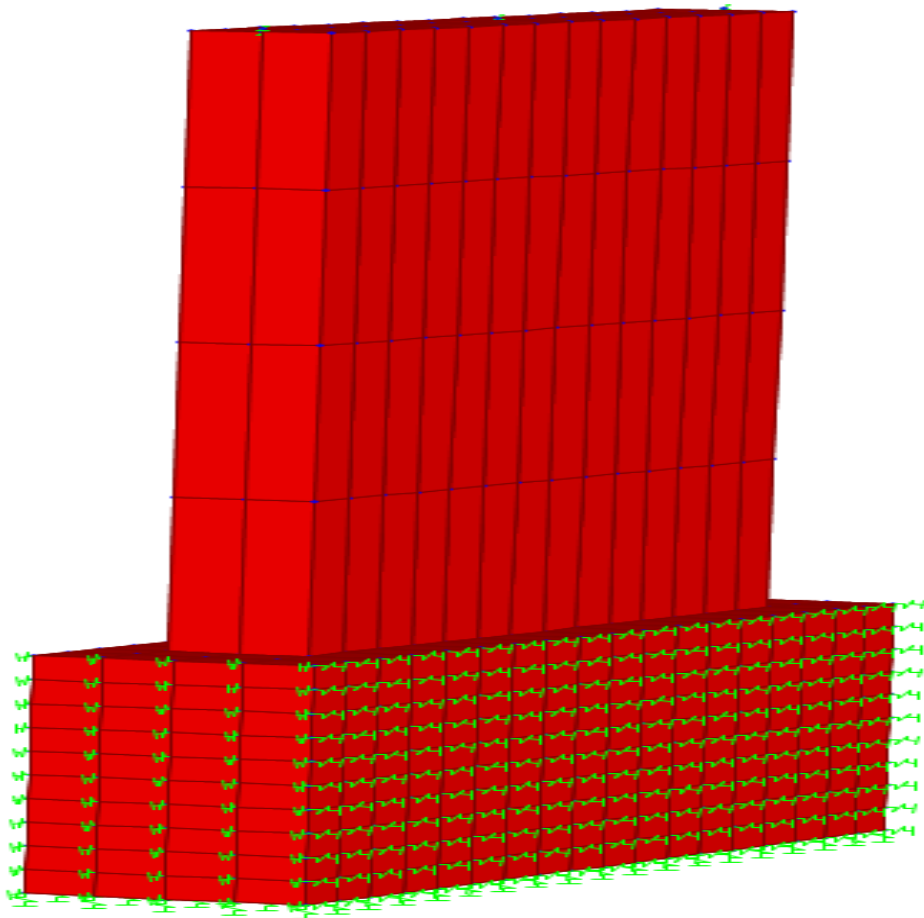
Vista de la subestructura en 3D del puente Jaltepec
